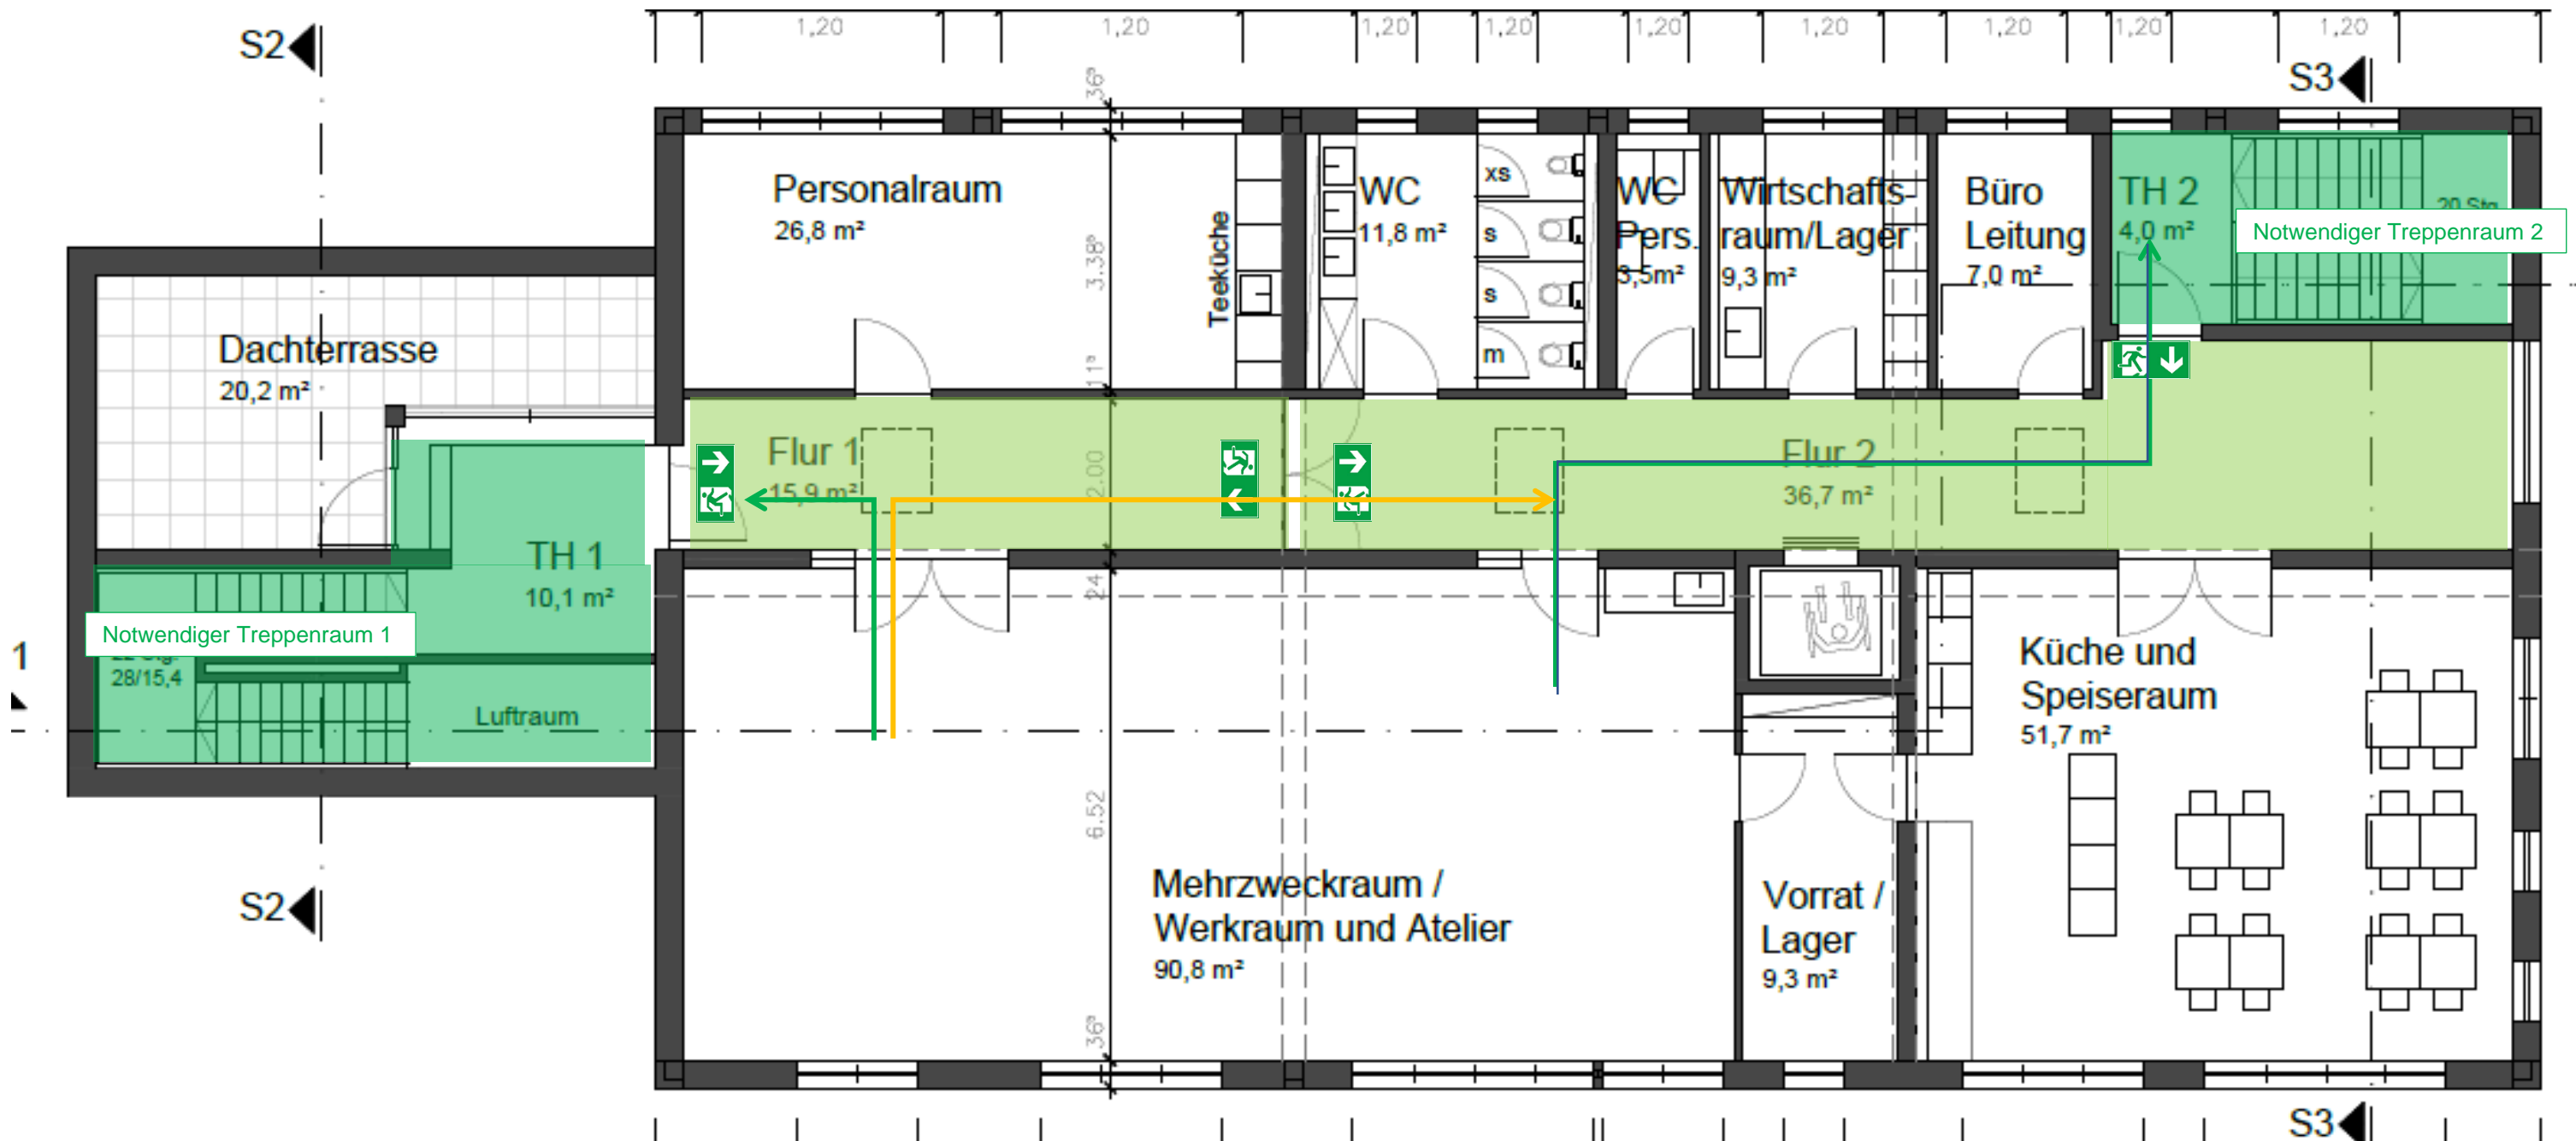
Grundriss 3. Obergeschoss
